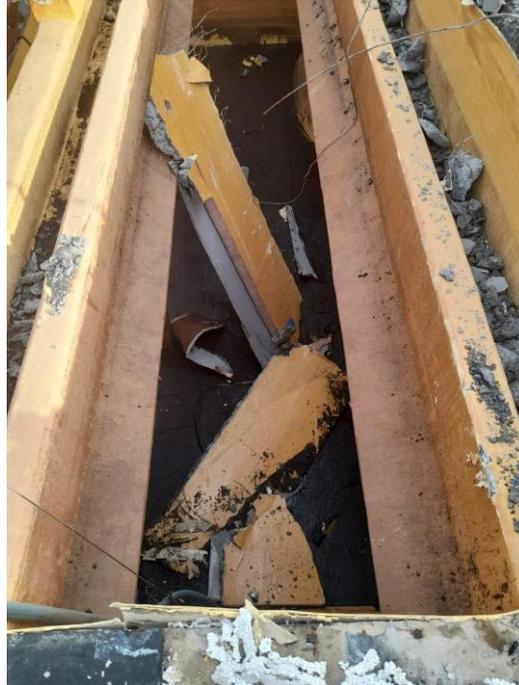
Partes da laje inclinadas e apoiadas na estrutura existente.
